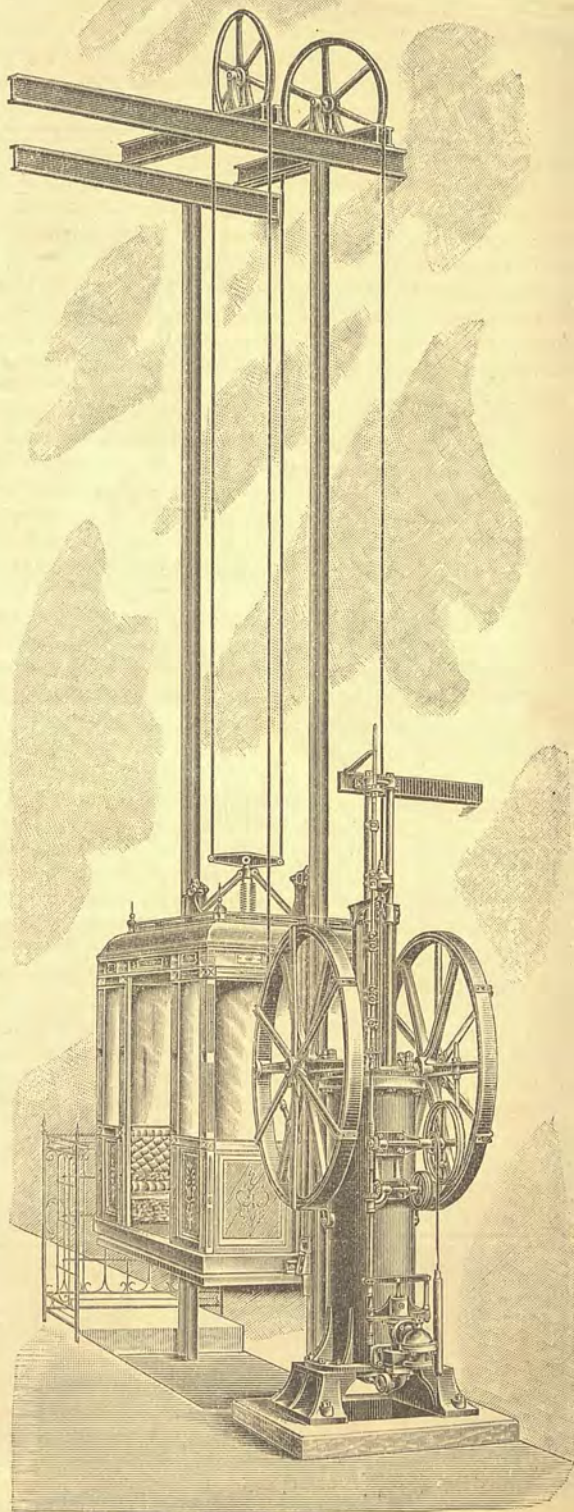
Disposizione di un ascensore sistema Stigler con macchina idraulica verticale.
